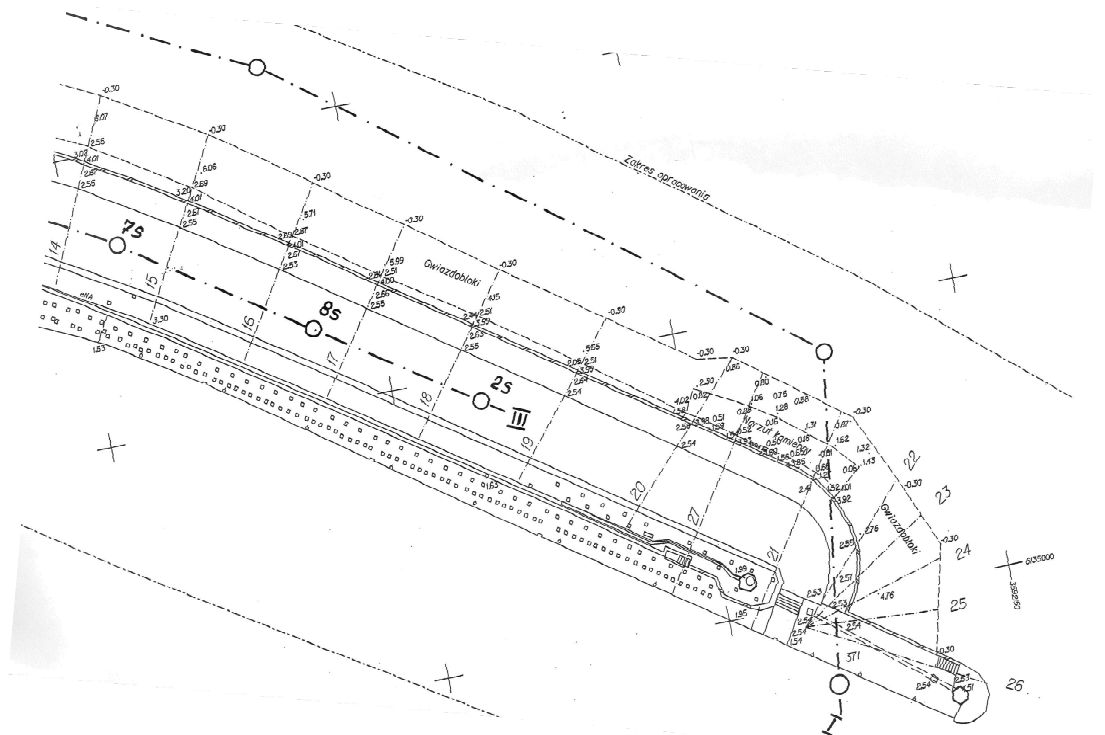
Plan batymetryczny w sąsiedztwie Portu Władysławowo [5]
